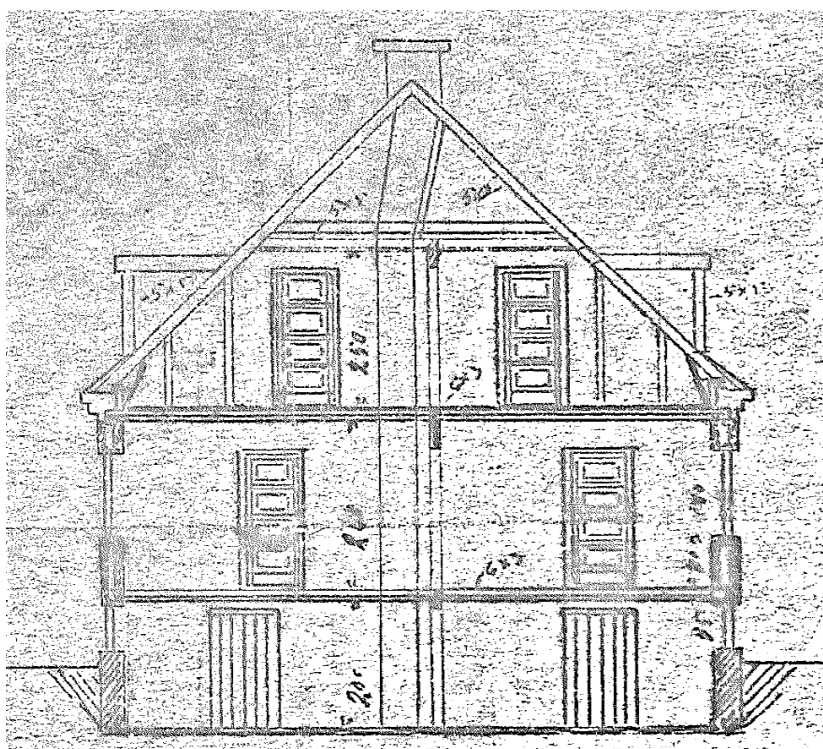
viser situationsplan, oprindelig plan, snit, facader og gavle.
